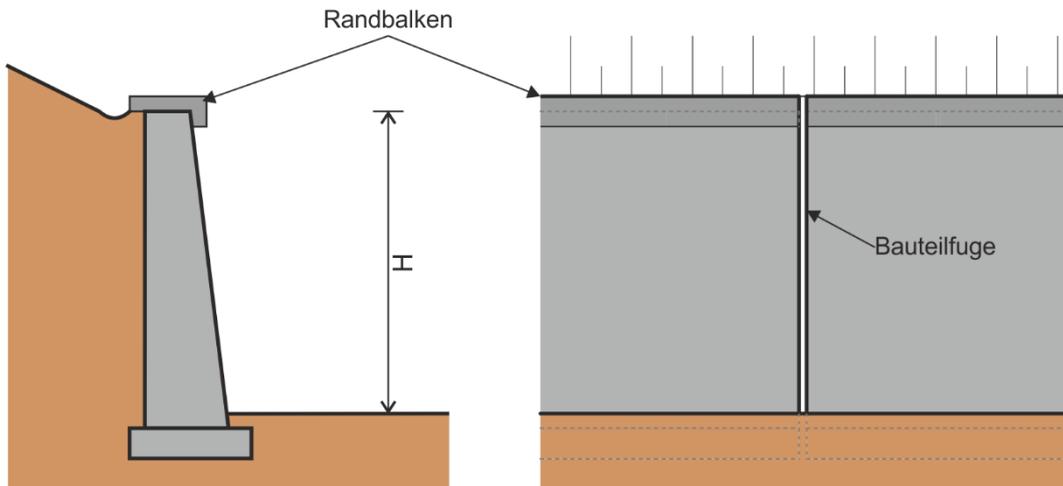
Schnitt und Längsansicht einer Gewichtsmauer
